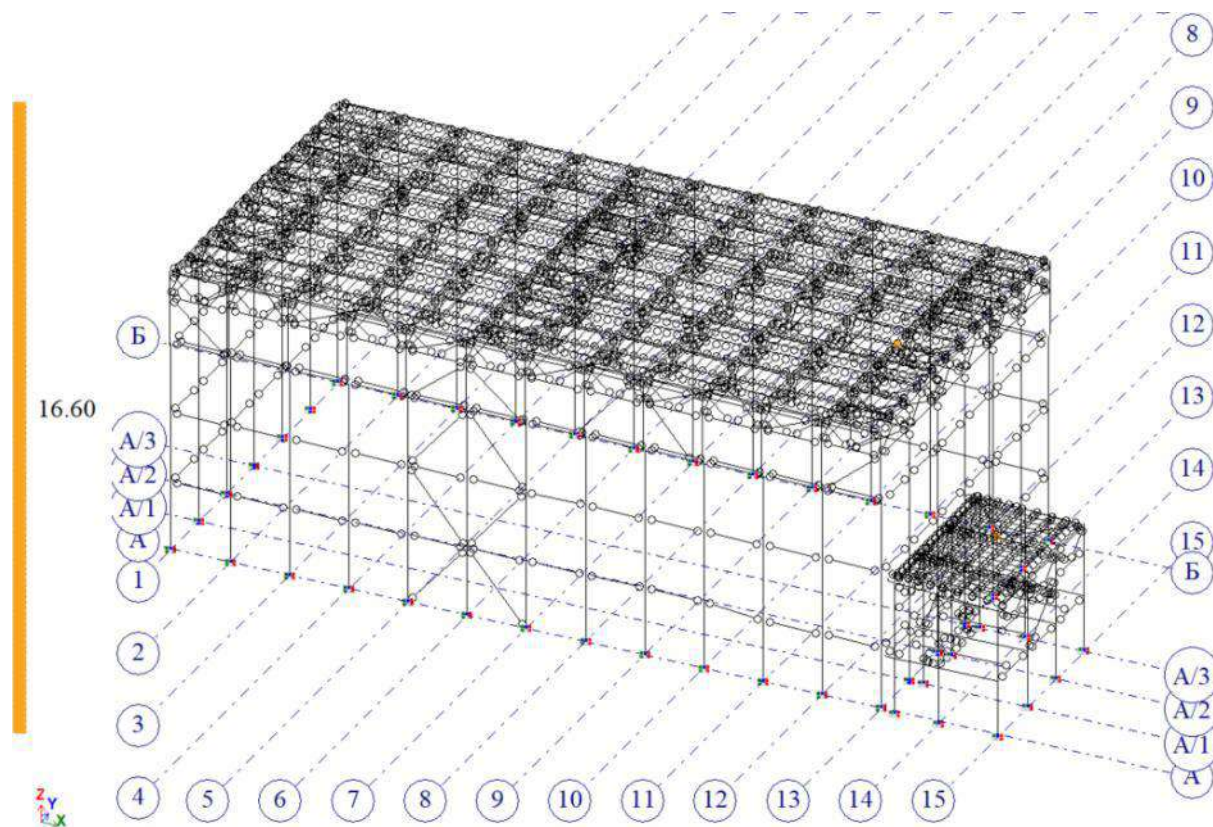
Нагрузка от подвесного кранового оборудования,
